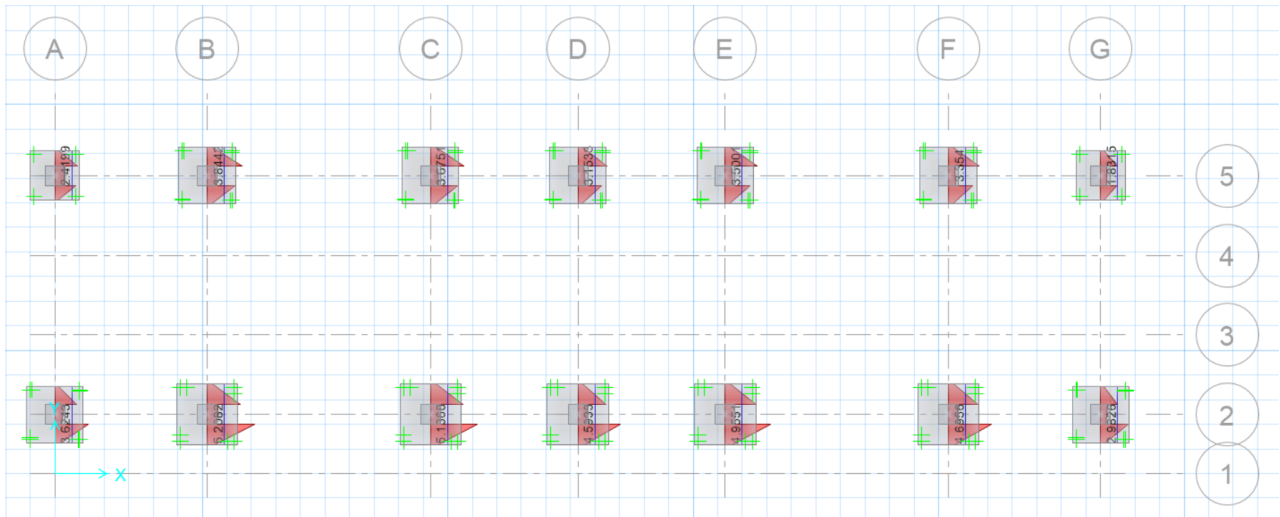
Armadura de refuerzo a flexión en zapatas aisladas eje x.
